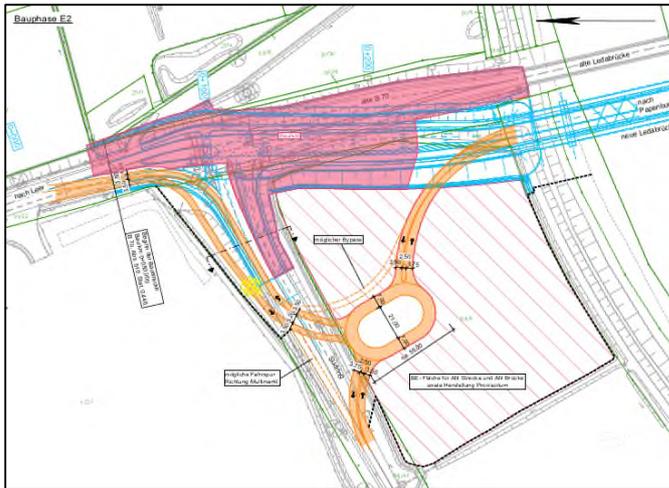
Lageplan Bauphasenplan Nord, Bauphase E2
